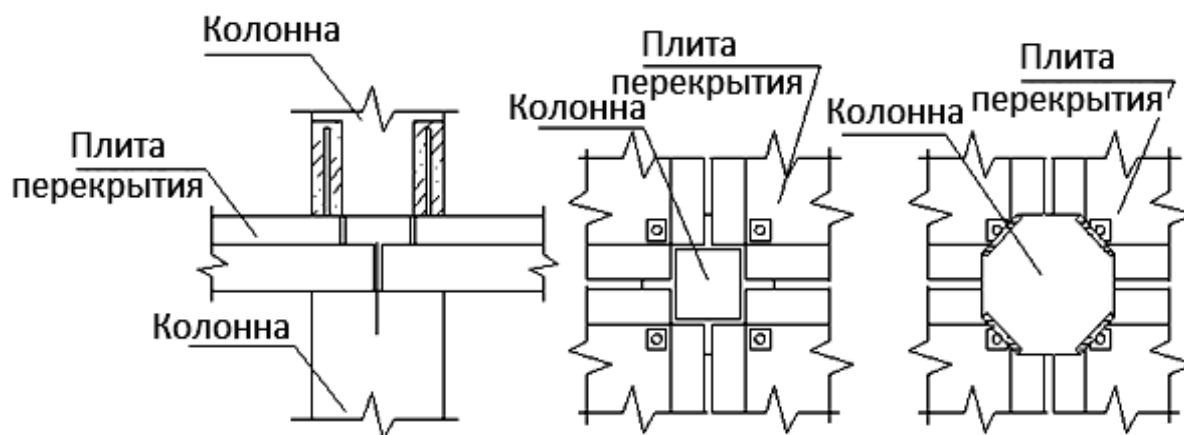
Узел сопряжения колонн с колоннами и плитами перекрытия
